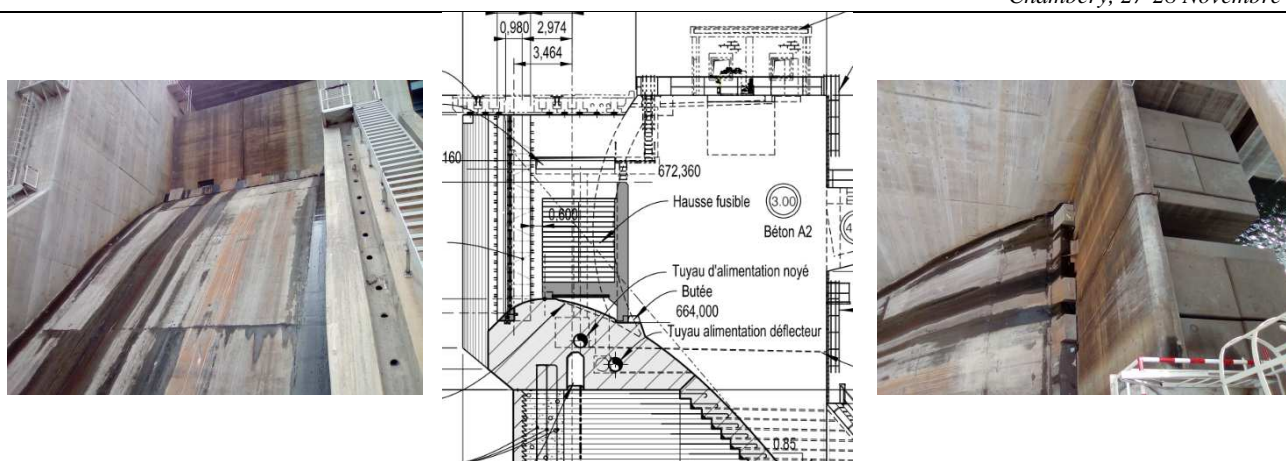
Haussse droite Hydroplus© sur seuil profilé, Barrage Lom Pangar - Cameroun, ISL/Tractebel
